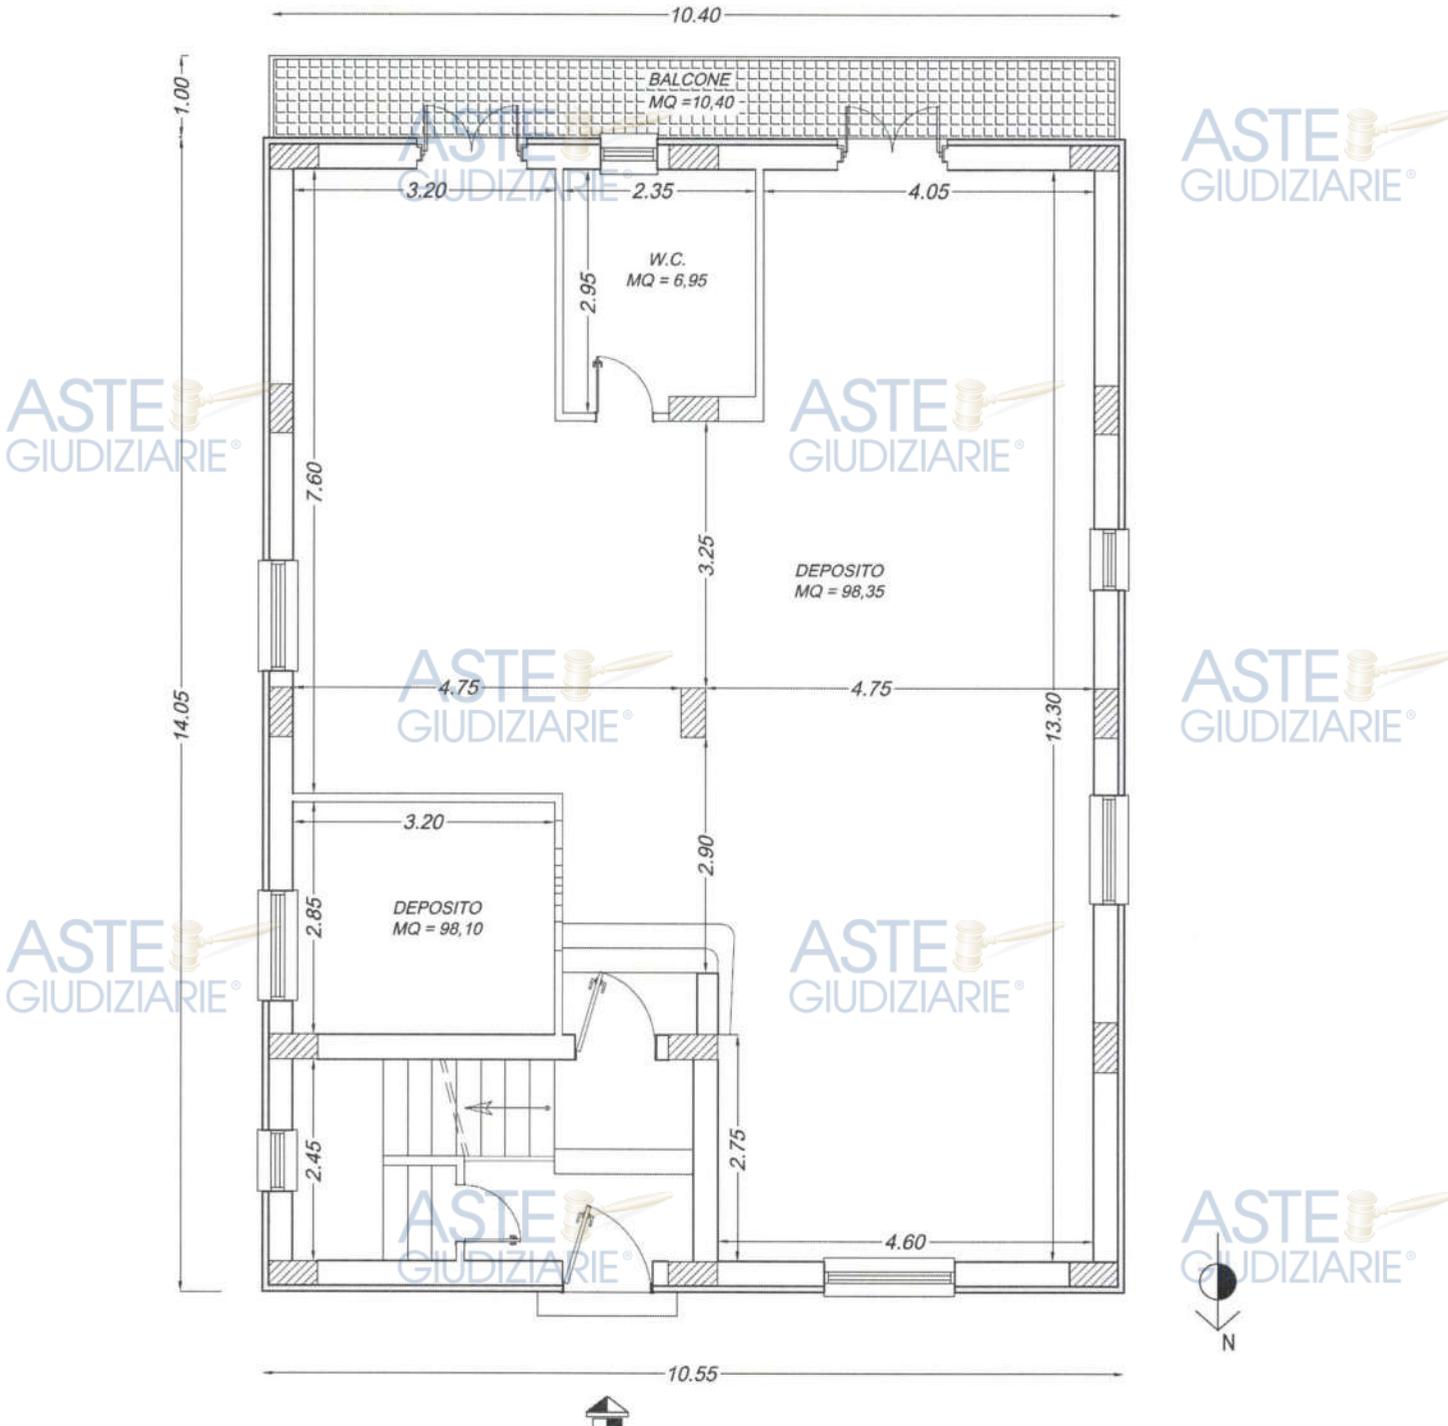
Planimetria Catastale Foglio 23, p.lla 371, sub 7 (ex sub 3) - Piano T
